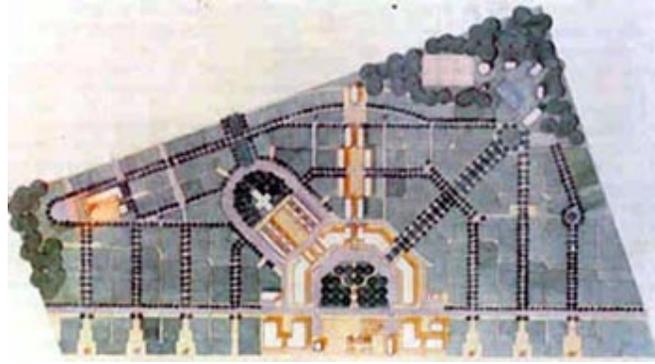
Planta de proyecto "Seaside", Walton County, Florida, 1981, Arq̄tos. Duany & Plater-Zyberk;
